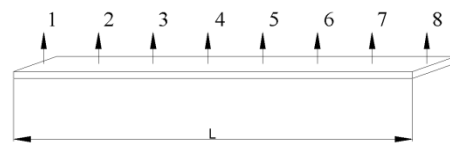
Distribución de los acelerómetros en las vigas de vidrio laminado
